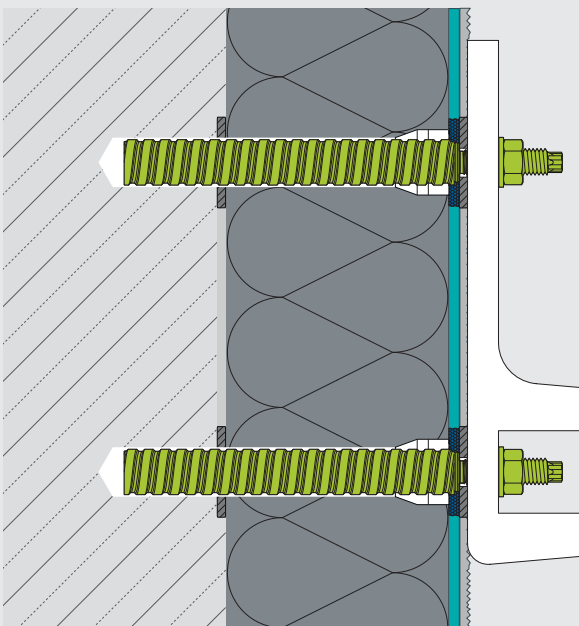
Wärmebrückenreduzierte Verankerung im Untergrund – das Montageelement wird nach Fertigstellung des WDVS im Untergrund verankert. Das Anbauteil wird an dem Montageelement befestigt.
